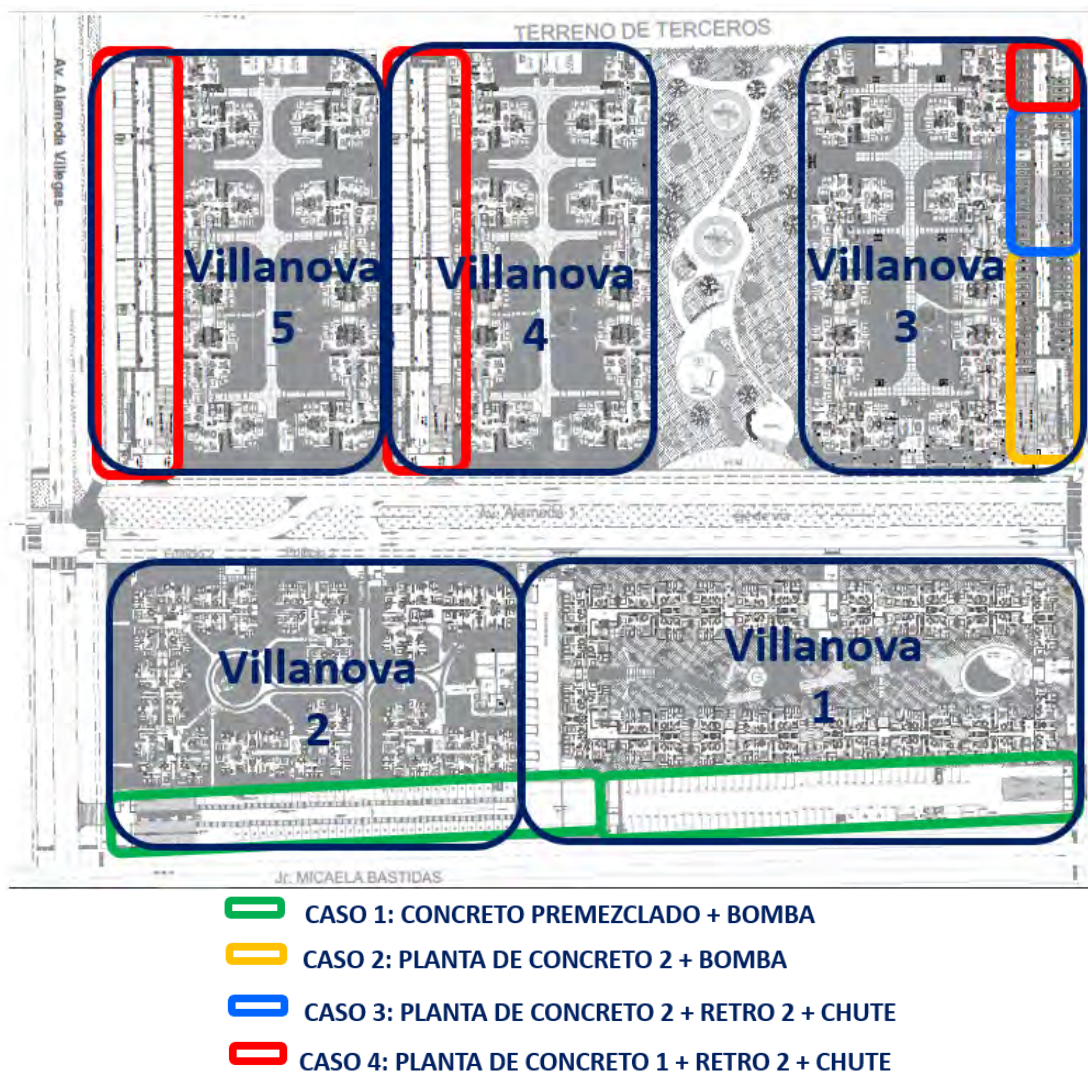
Planimetría del proyecto Villanova – 5 Etapas
